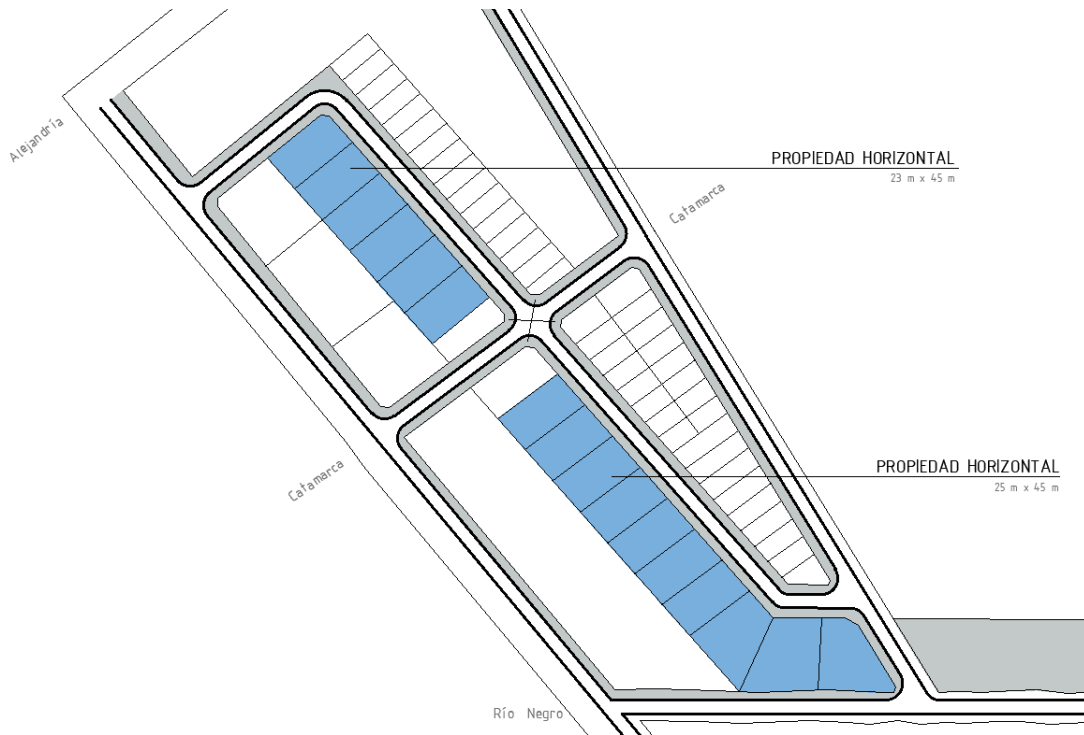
Ubicación de viviendas de propiedad horizontal.
